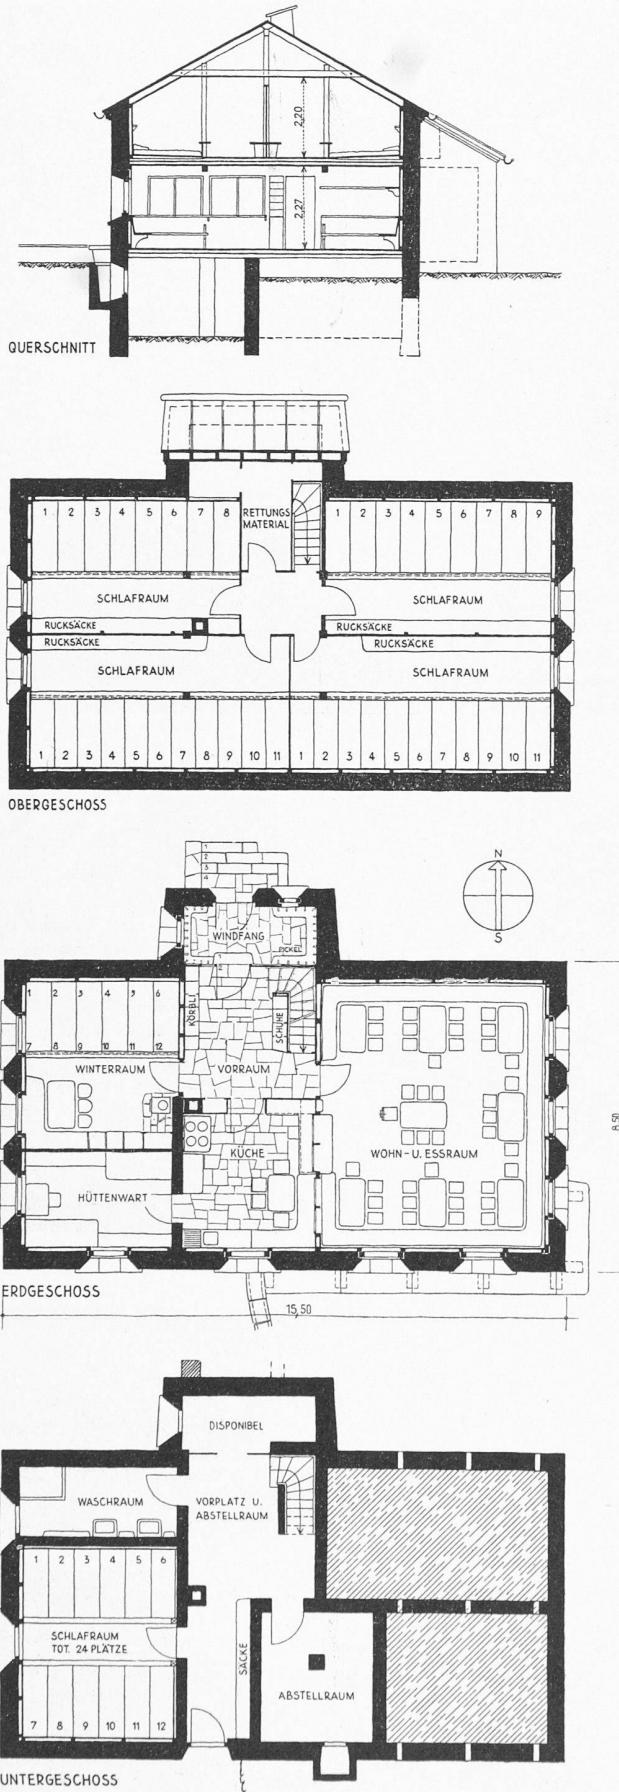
Querschnitt und Grundrisse 1:200
